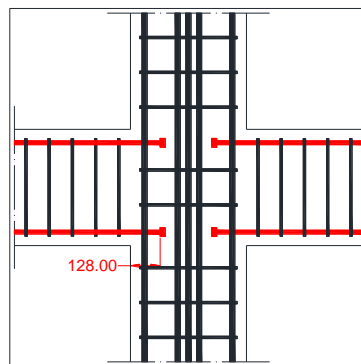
16 Detail Penulangan Hubungan Balok-Kolom Interior Menggunakan Headed Bar
